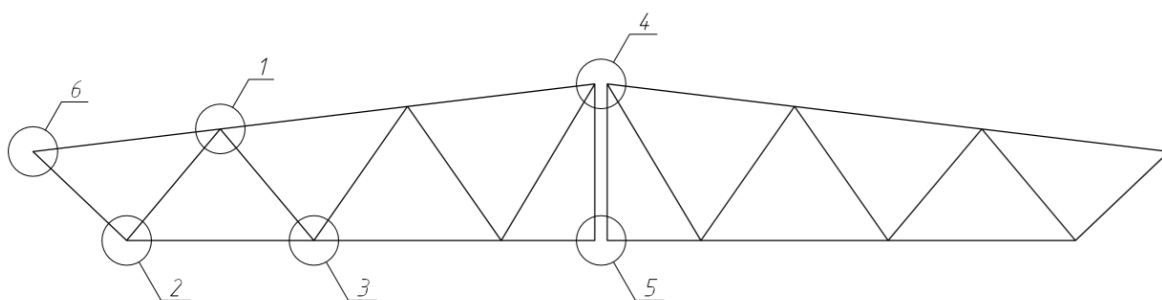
Схема расположения узлов к расчету и конструированию узлов фермы
